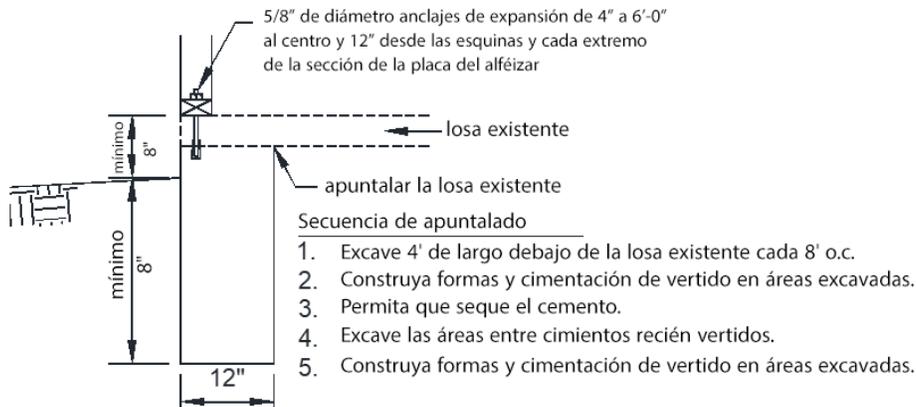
DETALLE TÍPICO DE APUNTALADO
